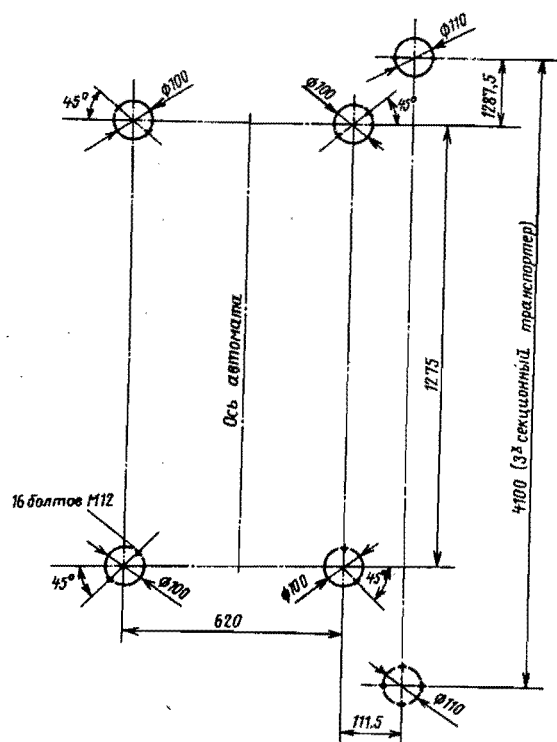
План расположения отверстий под фундаментные болты автомата марки АРУ-М
